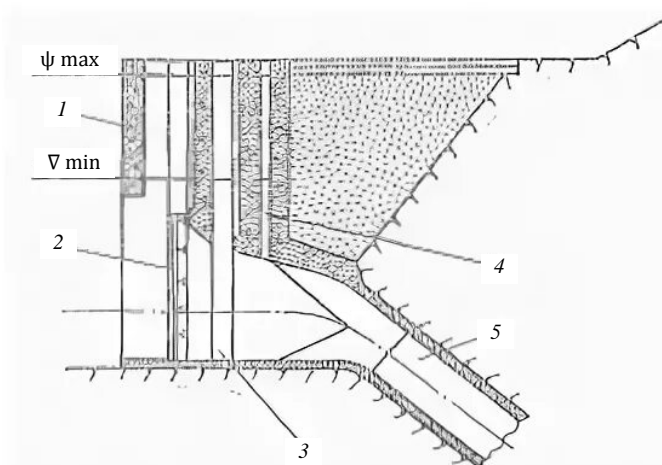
Схема глубокого берегового водоприемника с засыпанной пазухой напорной стенки: 1 – забральная балка; 2 – сороудерживающая решетка; 3 – паз для затвора, 4 – воздухоподводящая труба; 5 – туннель
